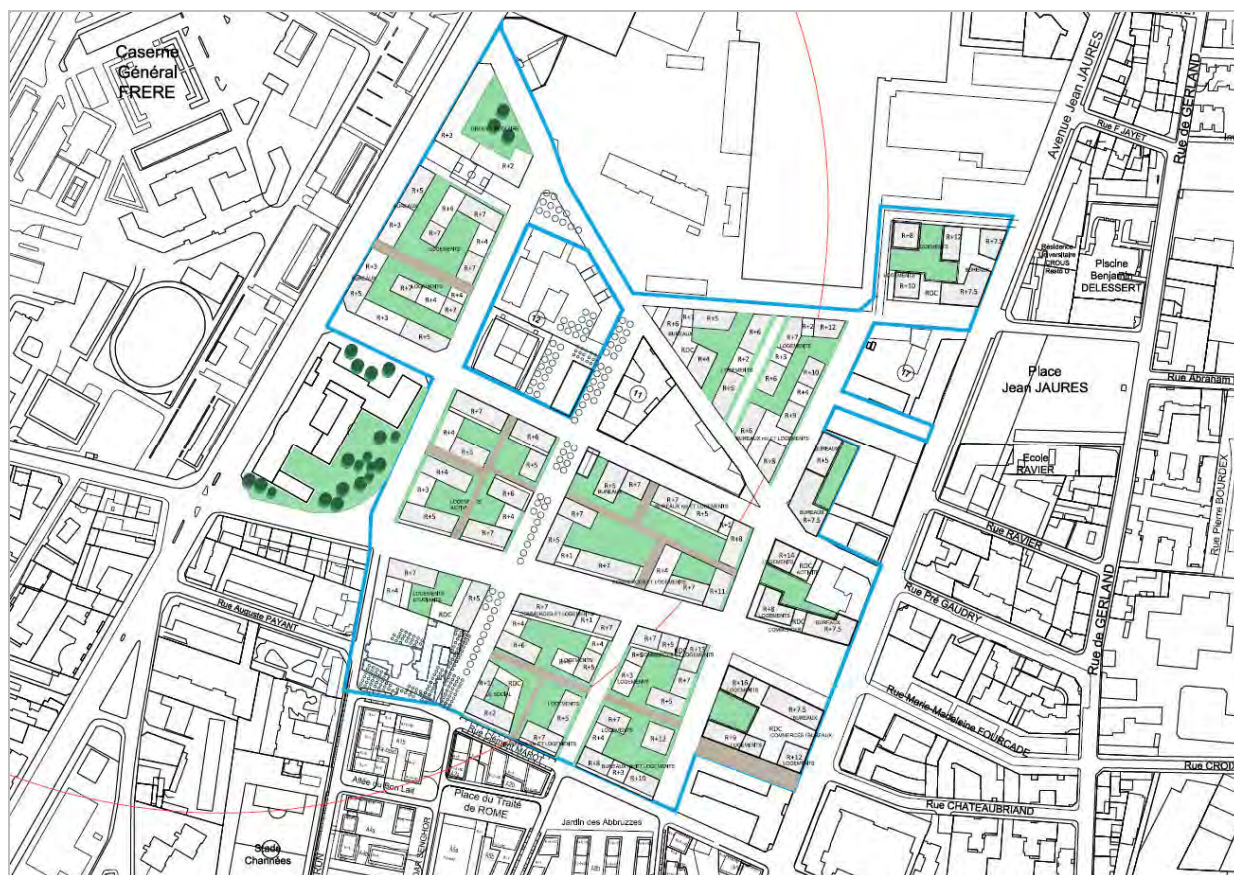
PLAN BATI PROJETE – PLAN MASSE REPRIS PAR TVK / BASE
